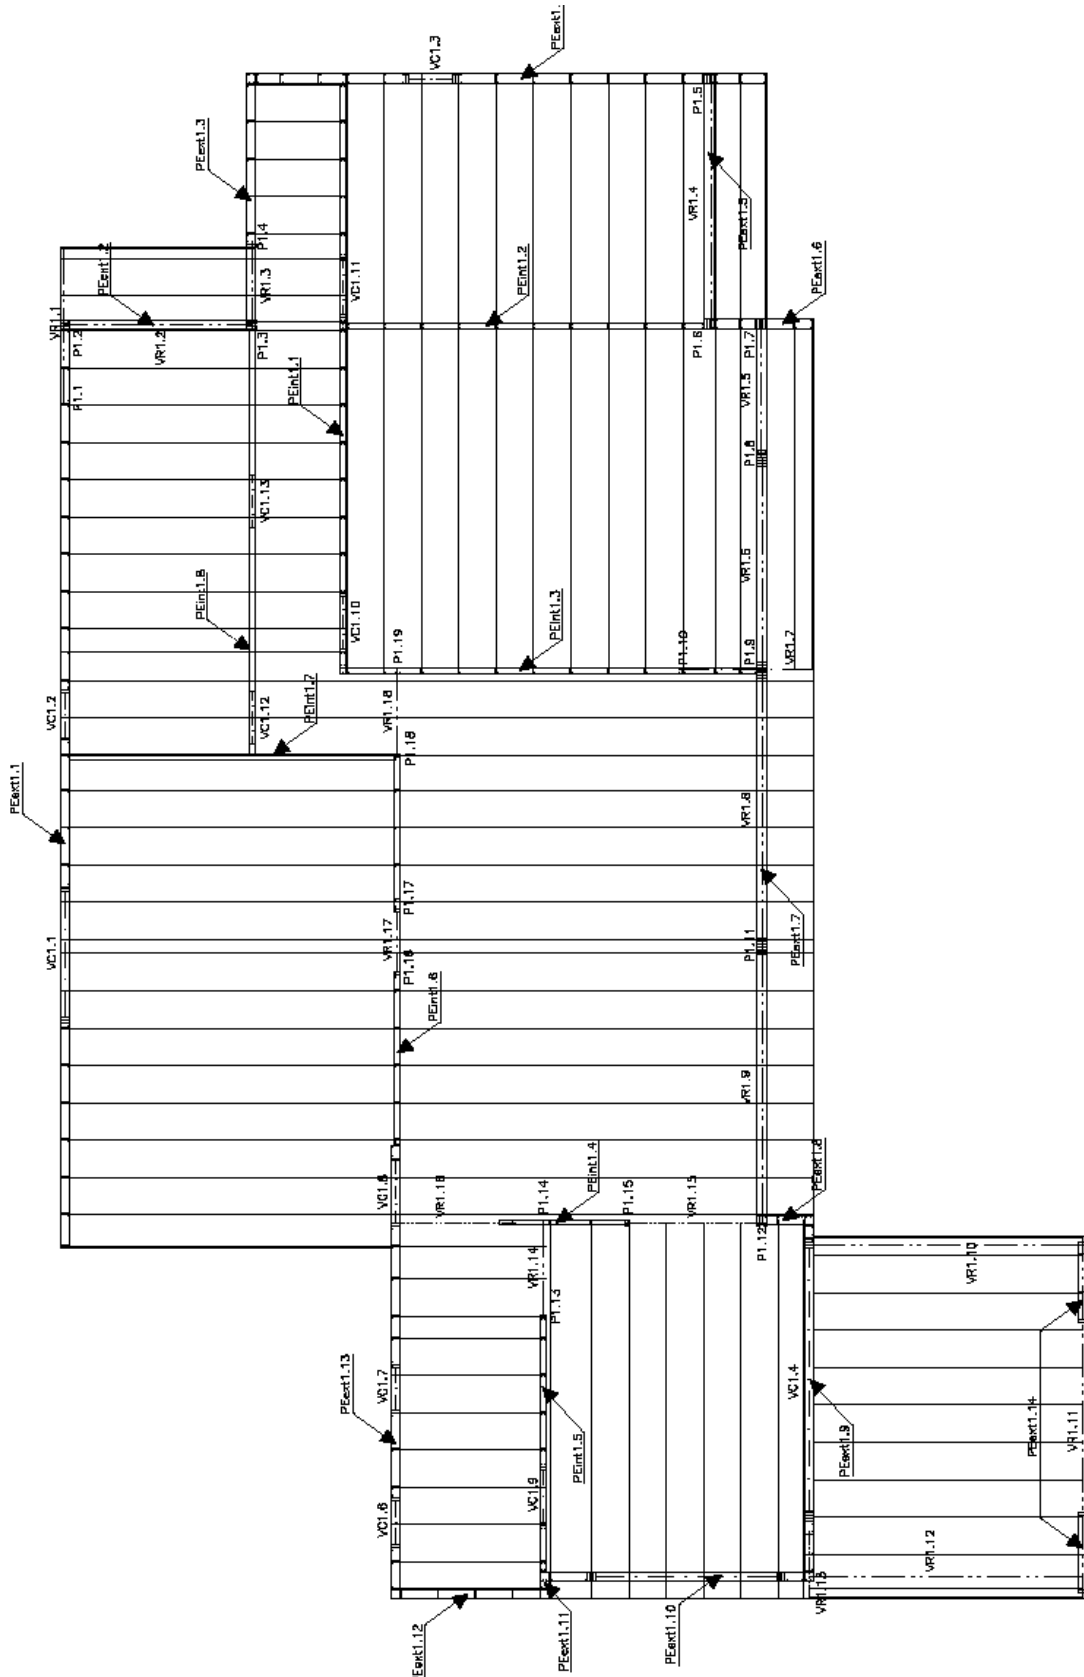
Planta do rés-do-chão dos montantes e das vigas.
